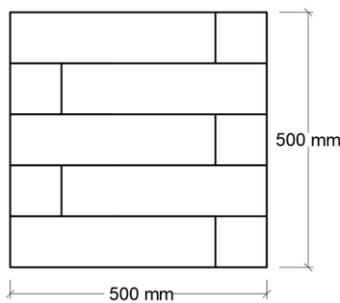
Dinding Batako dengan Metode *Reinforced Concrete Frame Infill Masonry
